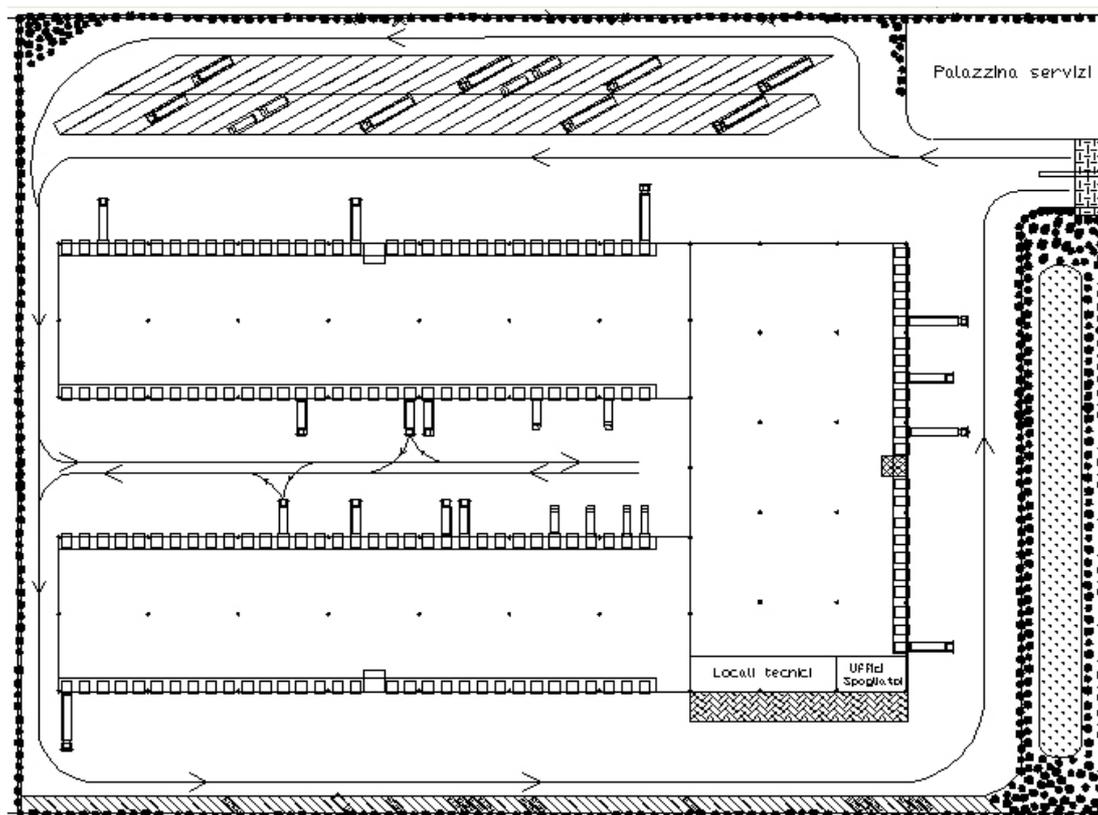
Ipotesi di struttura e layout della piattaforma
